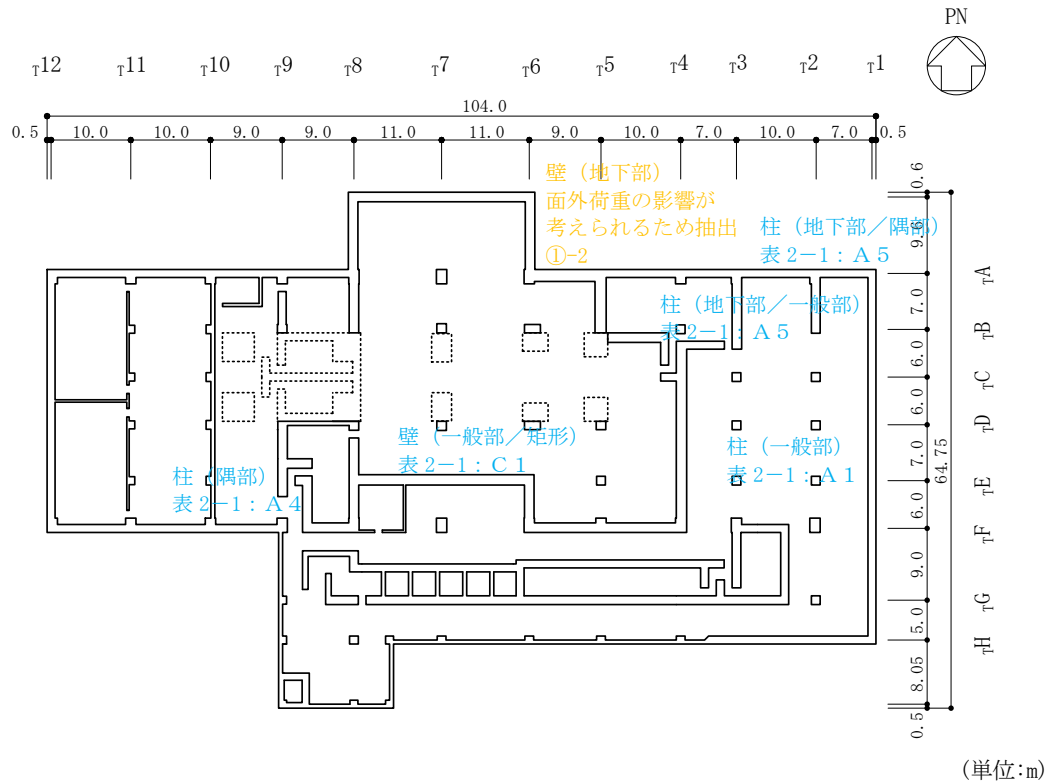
1号機タービン建物の概略平面図 (EL 1.8m)
